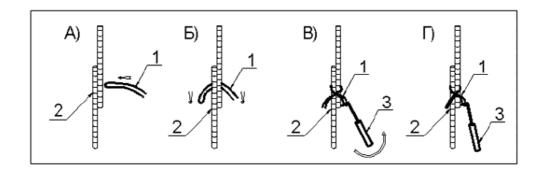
Схема фиксации вертикальных арматурных стержней вязальной проволокой
